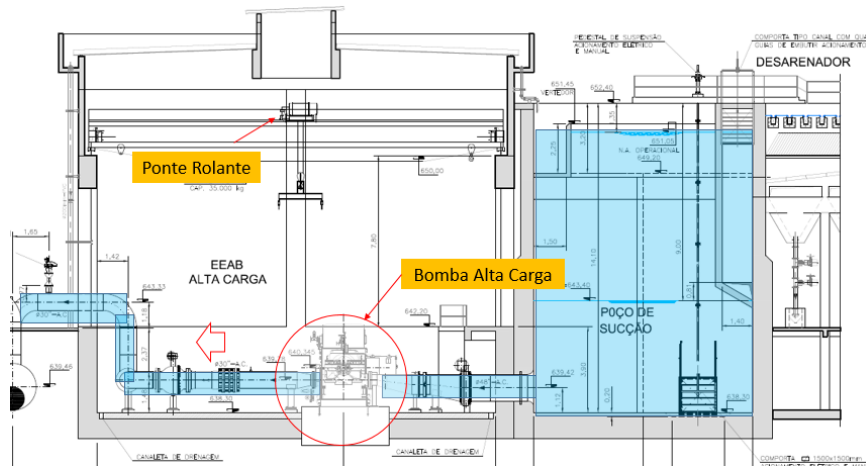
Casa de bombas da Estação Elevatória de Alta Carga, vista em Corte
